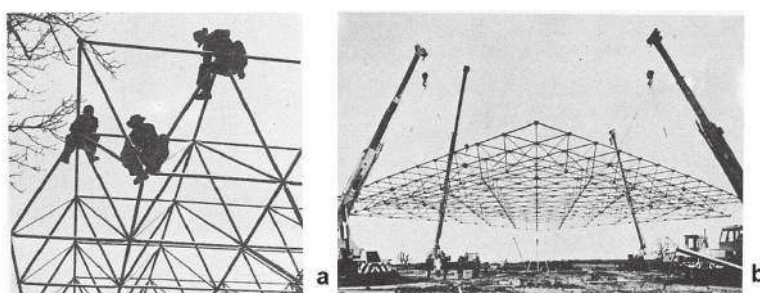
Montaggio delle strutture reticolari: a) montaggio per parti; b) montaggio a terra e successivo sollevamento (cd. *lift slab*; daPrete 1976)
